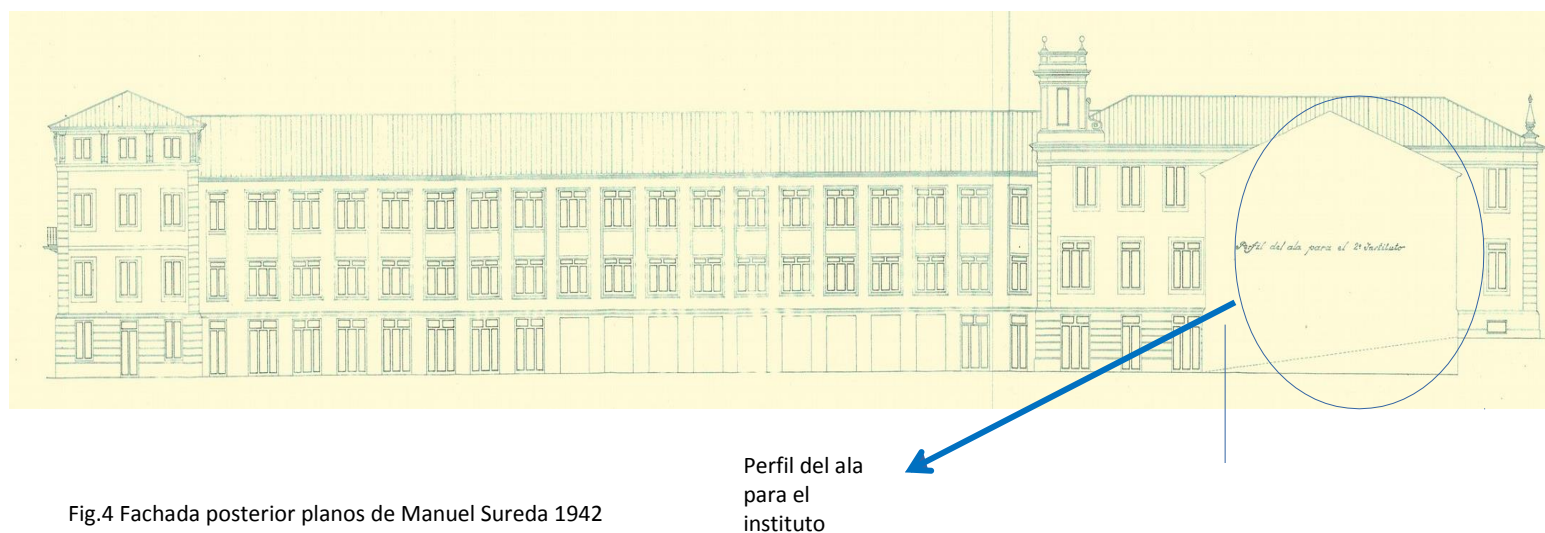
Fachada posterior planos de Manuel Sureda 1942
